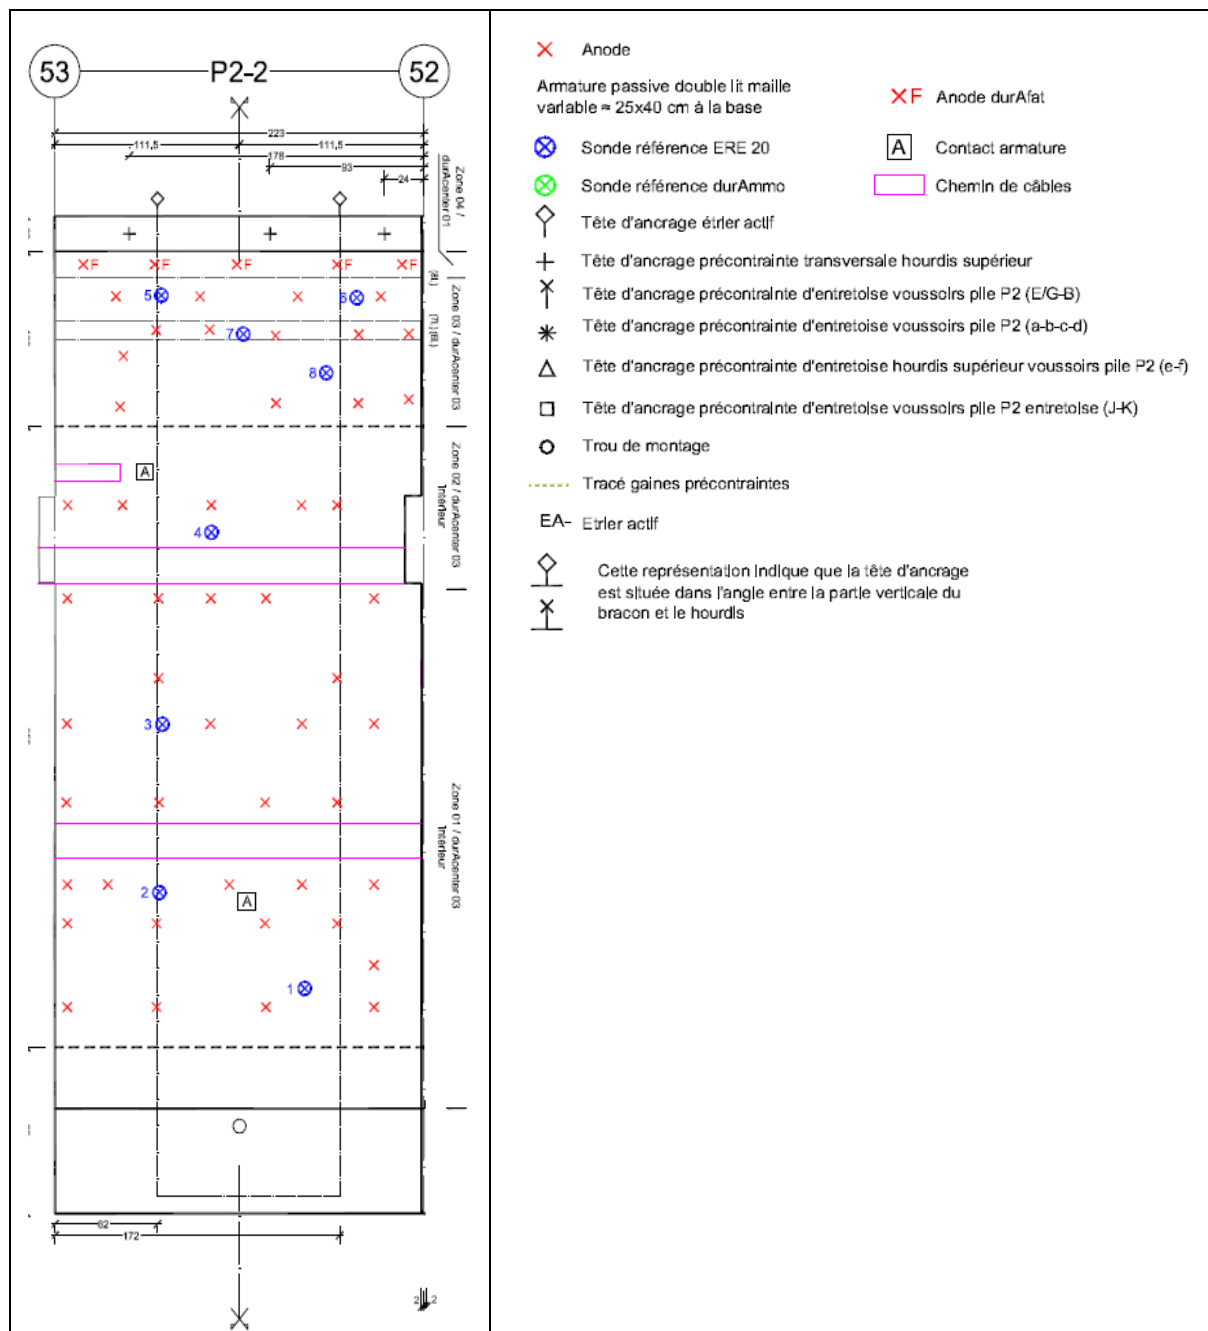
Exemple de plan de recollement de l'installation, voussoir P2-2 (durAcenter 03)
